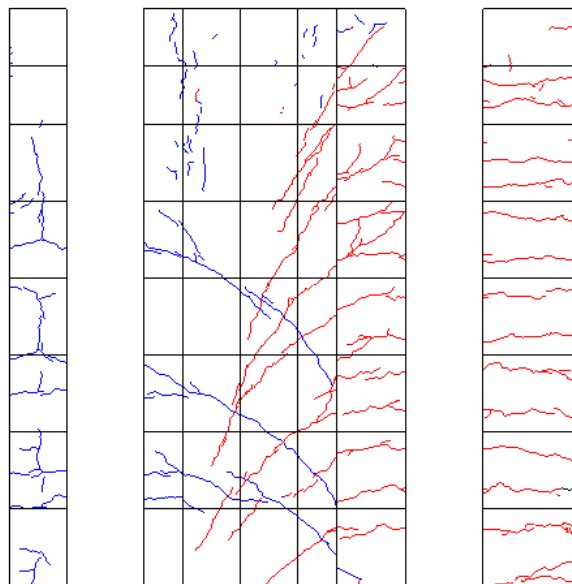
R=-1/133②ひび割れ図
